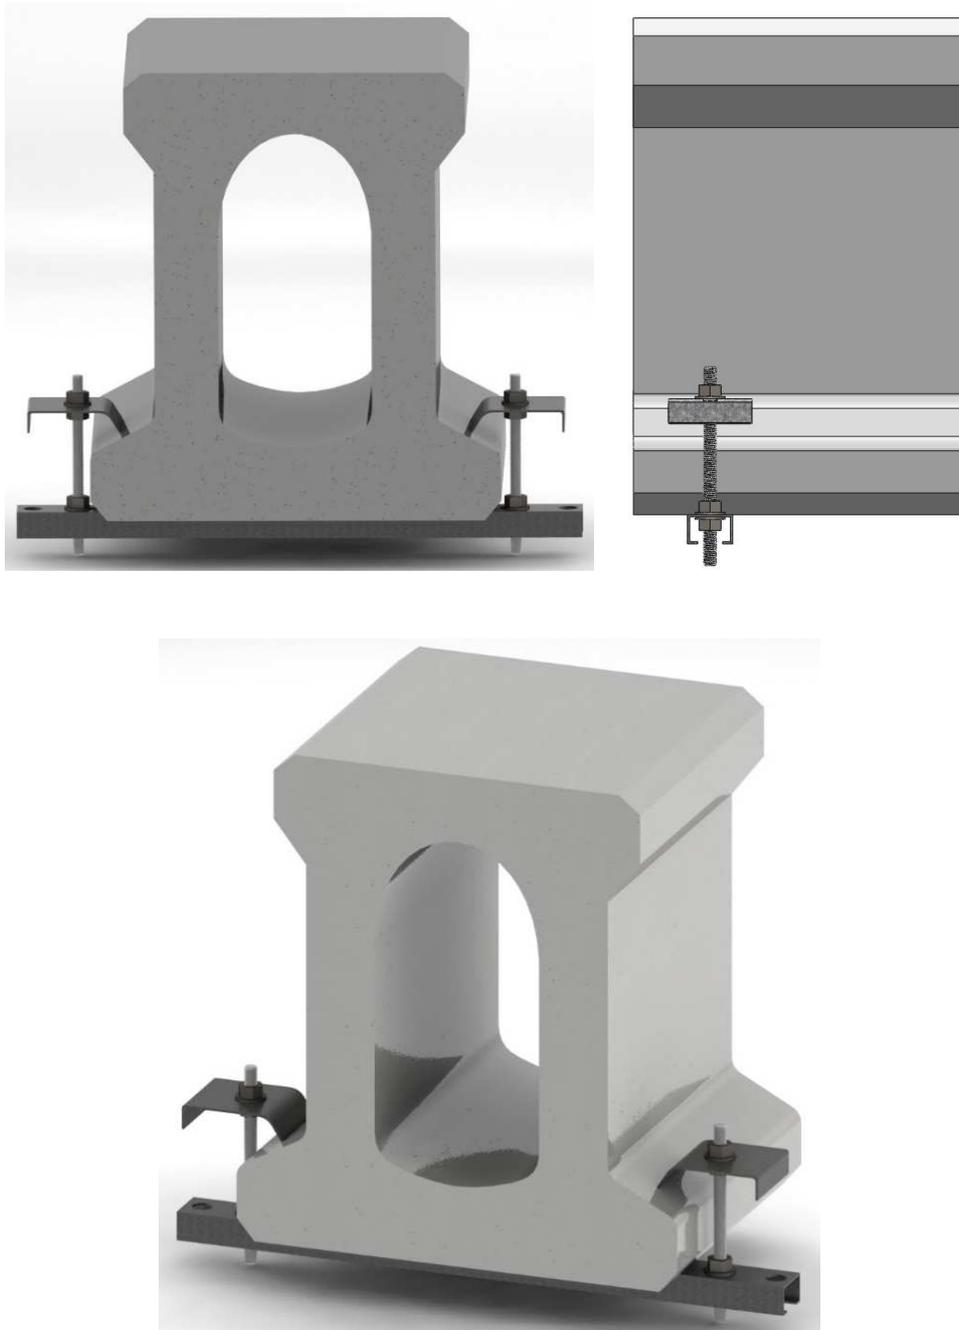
Sistema de sujeción propuesto instalado en viga de hormigón pretensado.
